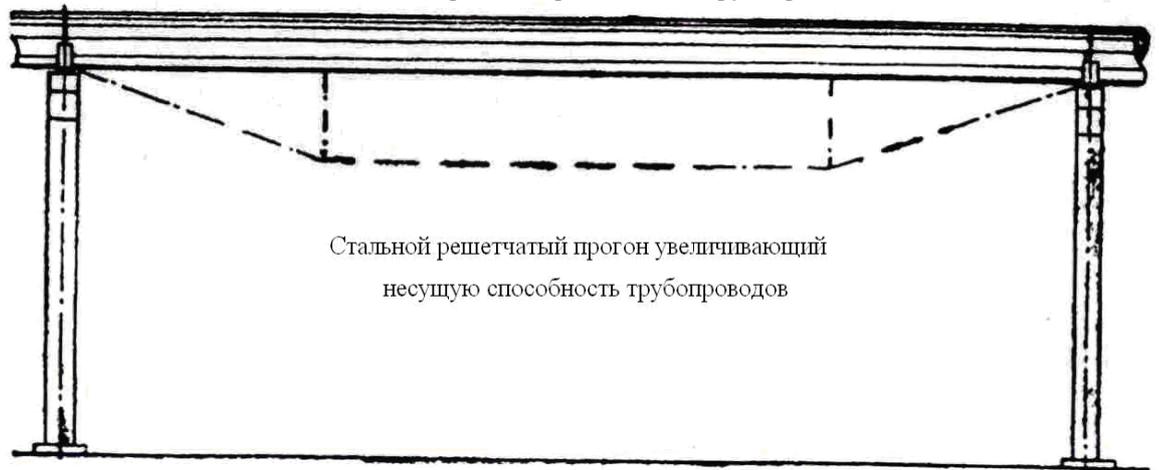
Прогонное (стоечно-балочное) решение опорных конструкций трубопроводов
